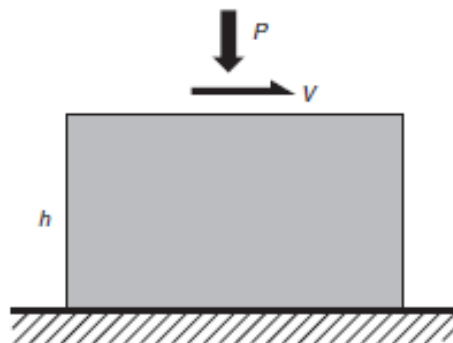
Modelo de cargas aplicadas a muros de corte de mampostería reforzada
